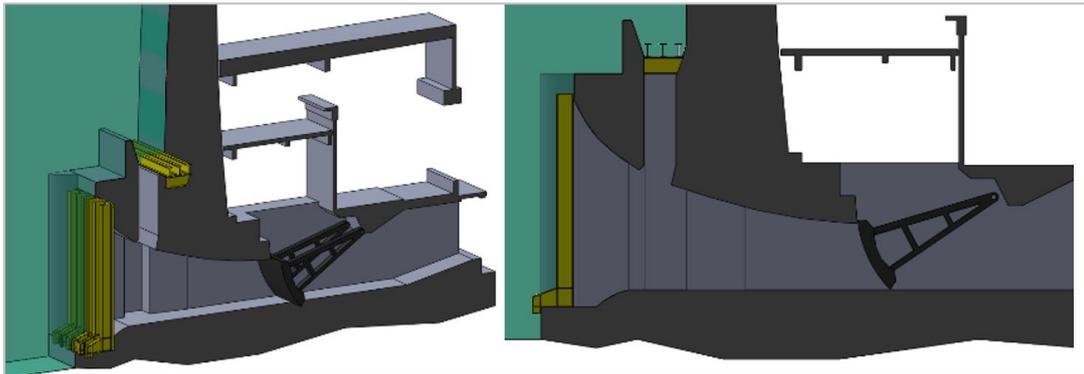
Batardeau d'isolement pour le chantier de la vanne wagon amont
